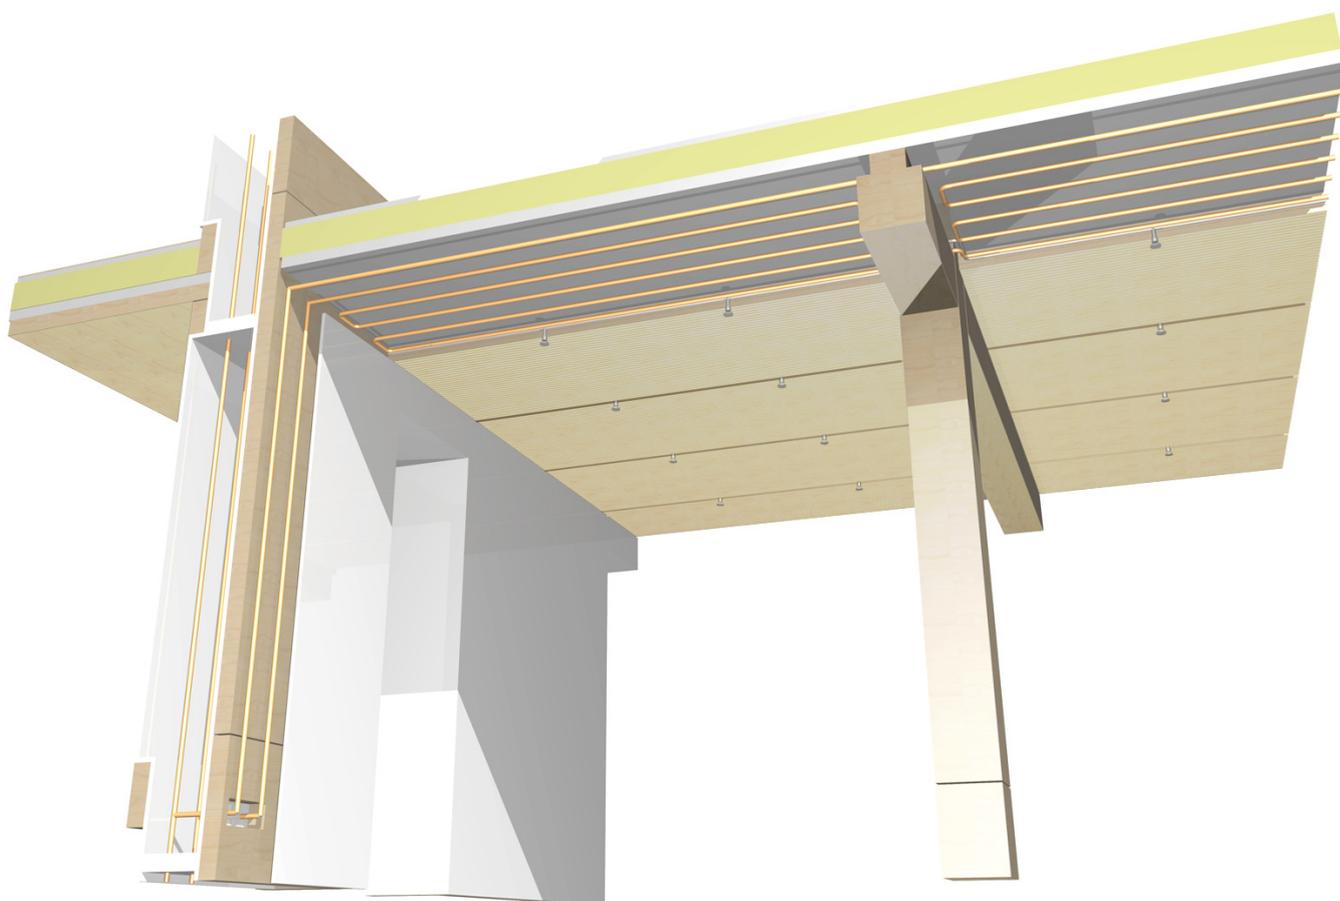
Detailperspektive mit Darstellung der Deckeninstallation in Schichten
